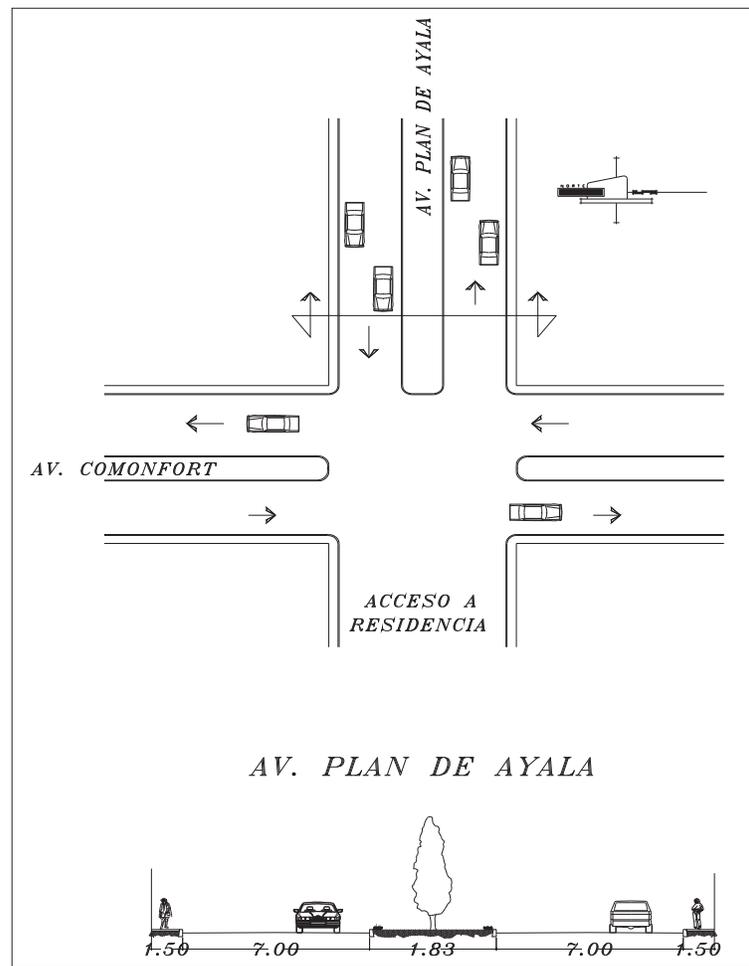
Corte transversal de la Av. Plan de Ayala.
